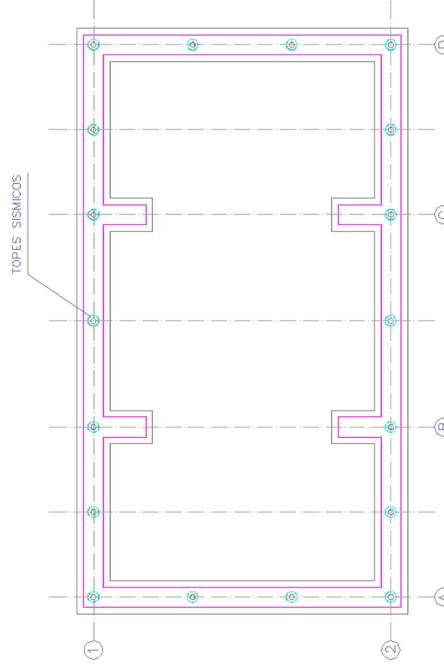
Planta de fundaciones de la estructura con topes sísmicos
